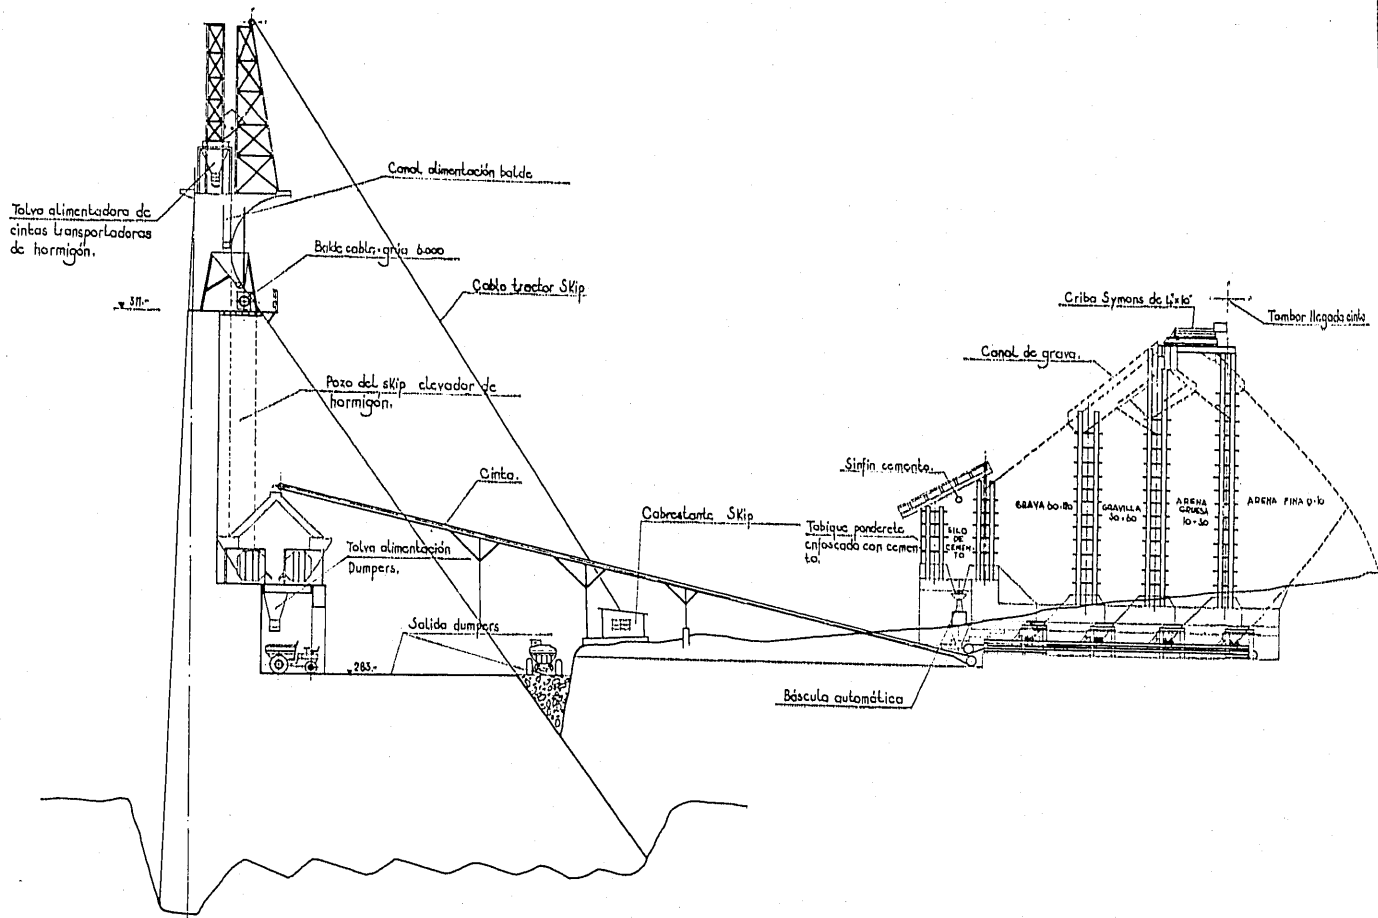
^a — Pantano de Orellana. Instalación principal y sistema de hormigonado. Alzado del conjunto de instalaciones.
